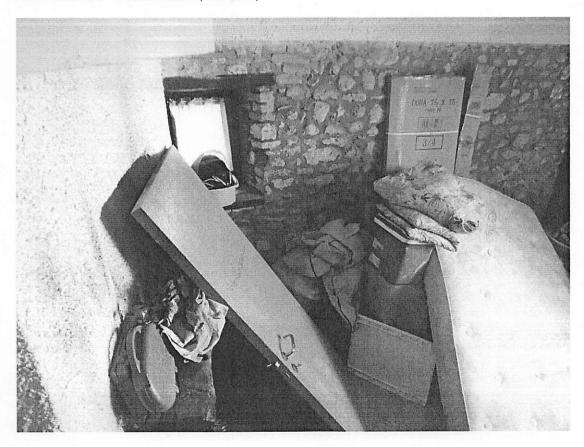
PIANO TERRA (foto n.16)
